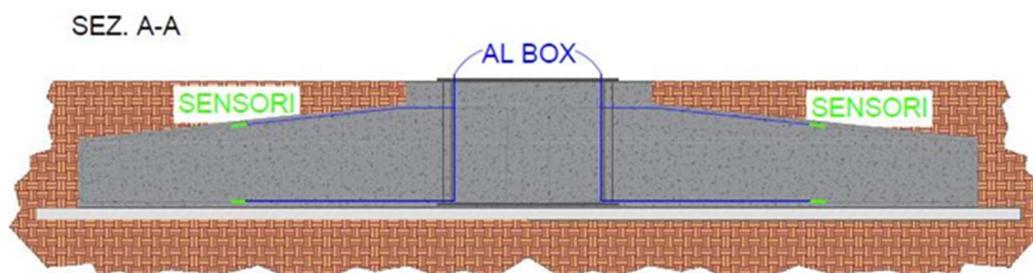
Schema tipo di montaggio dei sensori su una fondazione diretta
